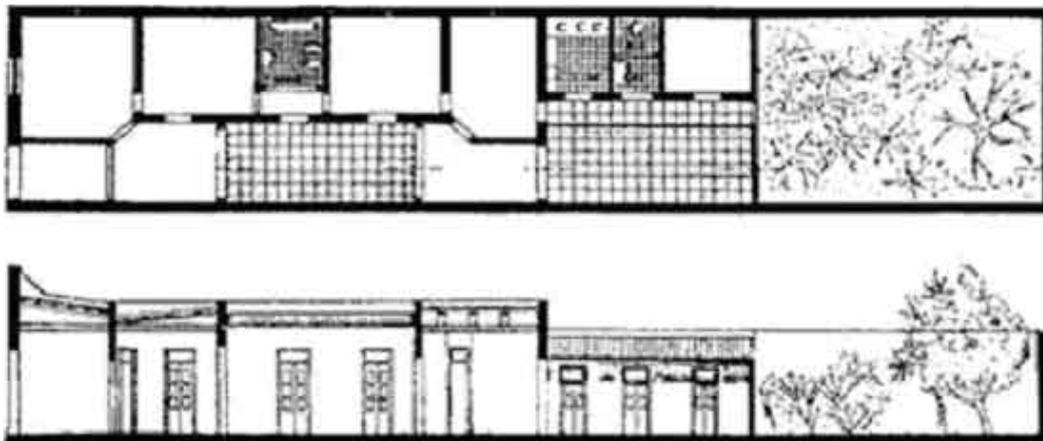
Planta y sección longitudinal de una casa chorizo. (Posadapalermo.com)
